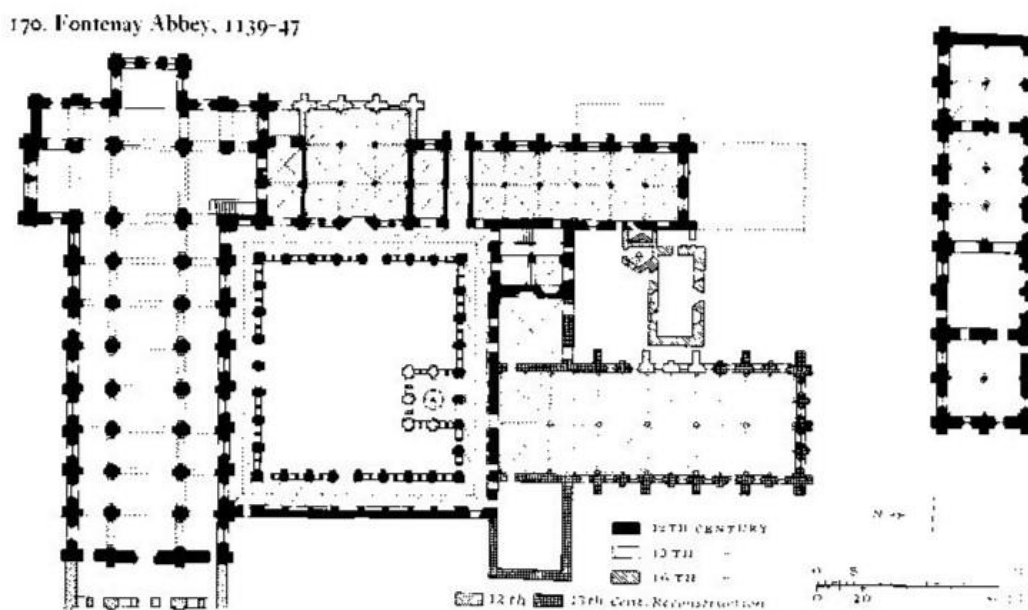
Planta da Abadia de Fontenay, fundado por São Bernardo de Clairvaux em 1118 e modelo de planta cisterciense. França, 1139-47
